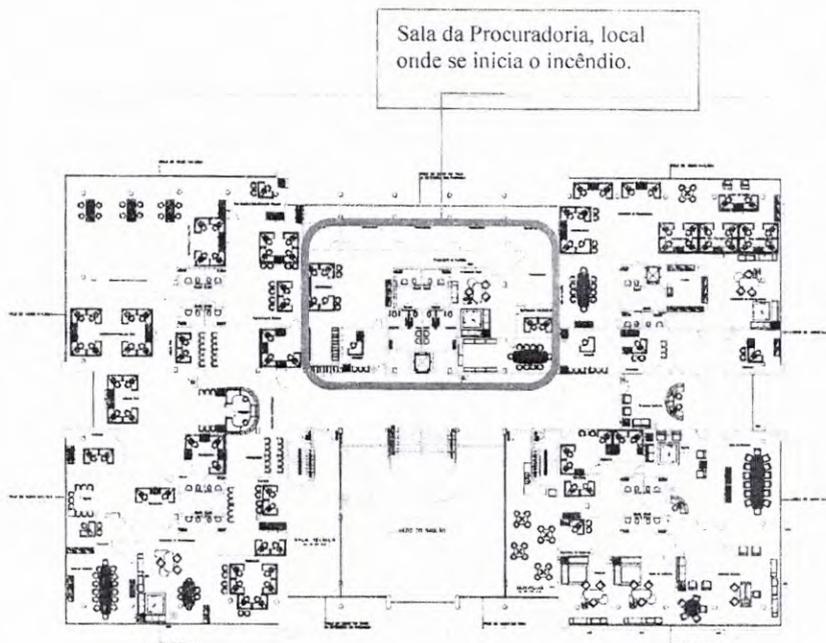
Terceiro pavimento, onde se iniciou o incêndio.
